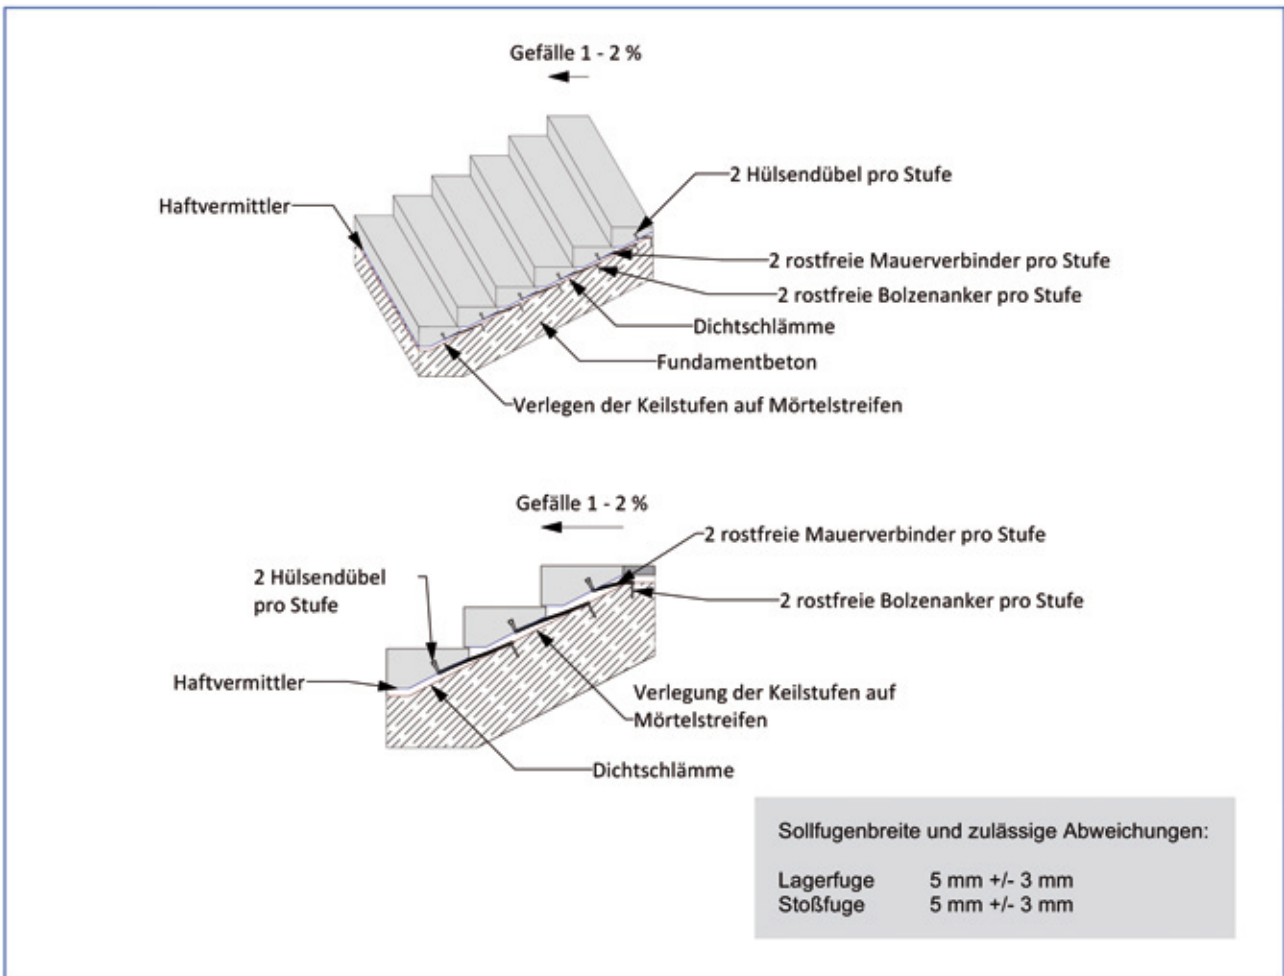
Beispiel einer Befestigung von Keilstufen auf vorbetonierter, bewehrter Betonrampe mittels Mauerverbindern
